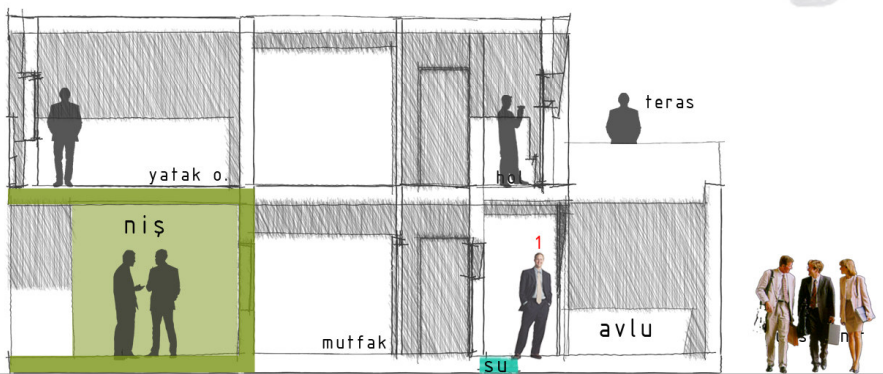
F tipi plan çözümü ve kütle gelişimi
